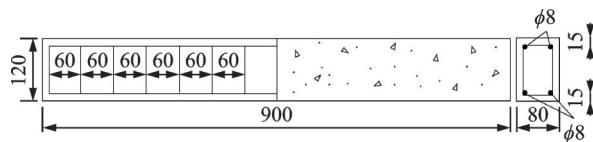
试验用钢筋混凝土梁的尺寸(单位:mm)
